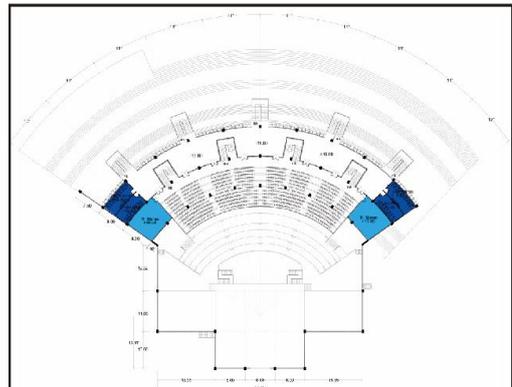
Denah Lantai 1 Gedung Pertunjukan Utama
